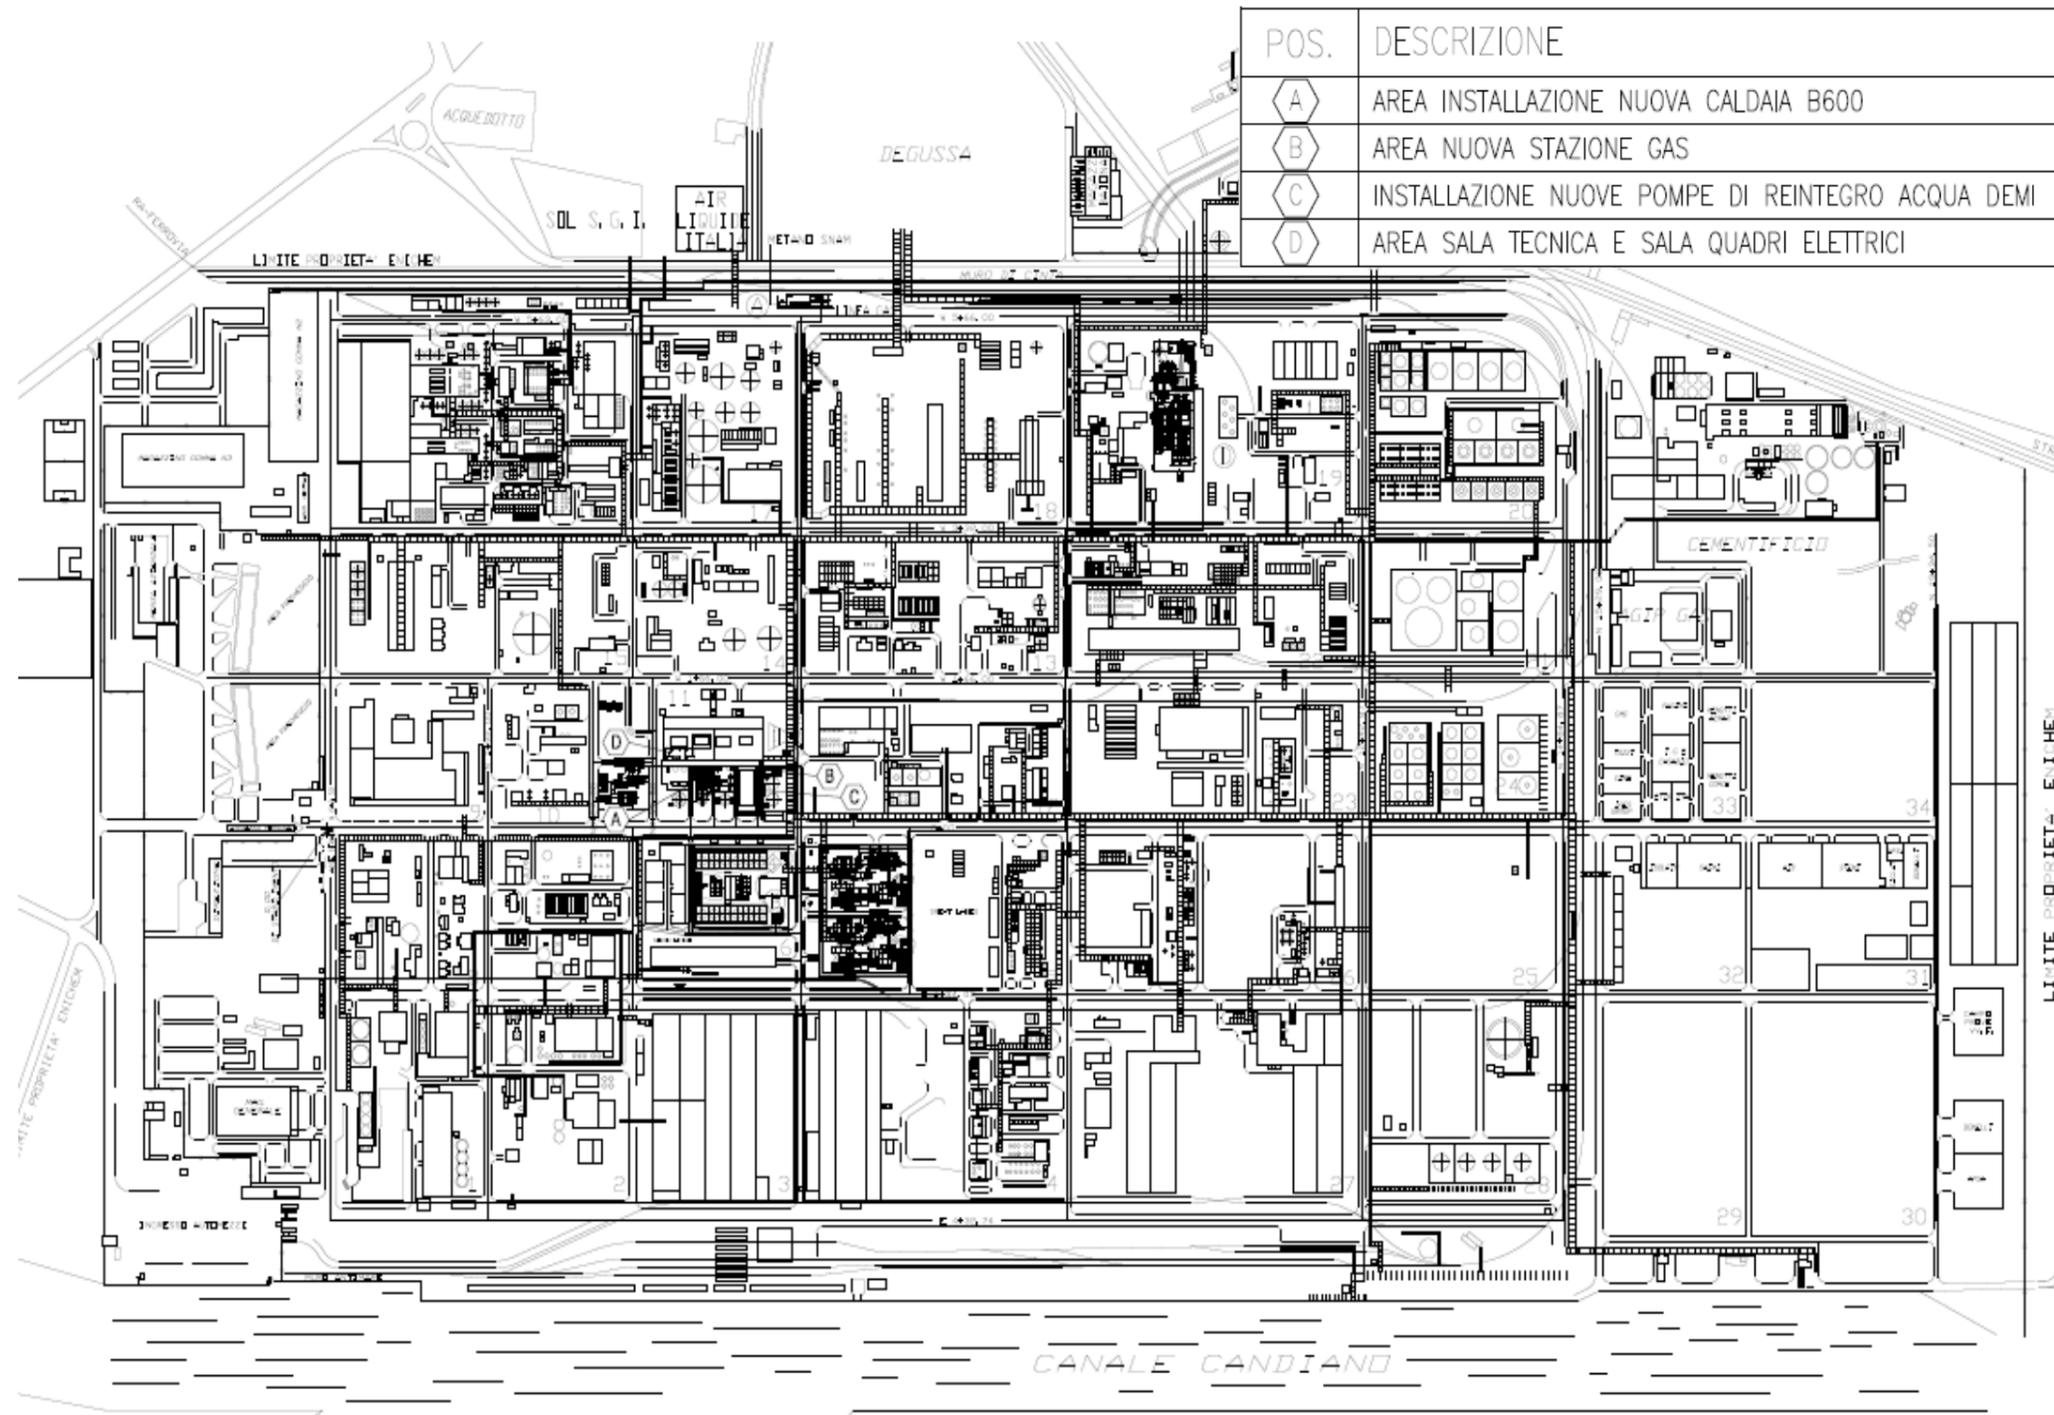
A – Planimetria generale nuove installazioni - isola 11
